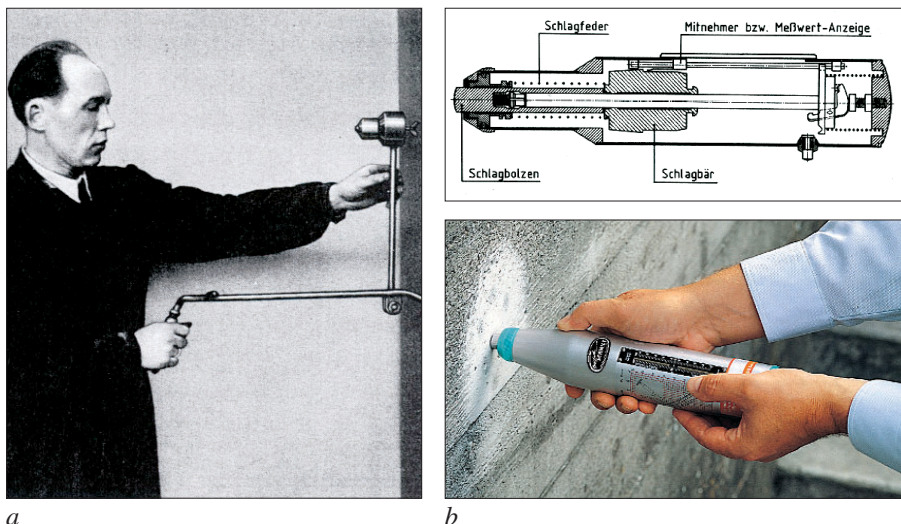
(a): Anwendung des Pendelhammers [1] (b): Rückprallhammer nach Schmidt Foto: www.proceq.ch
